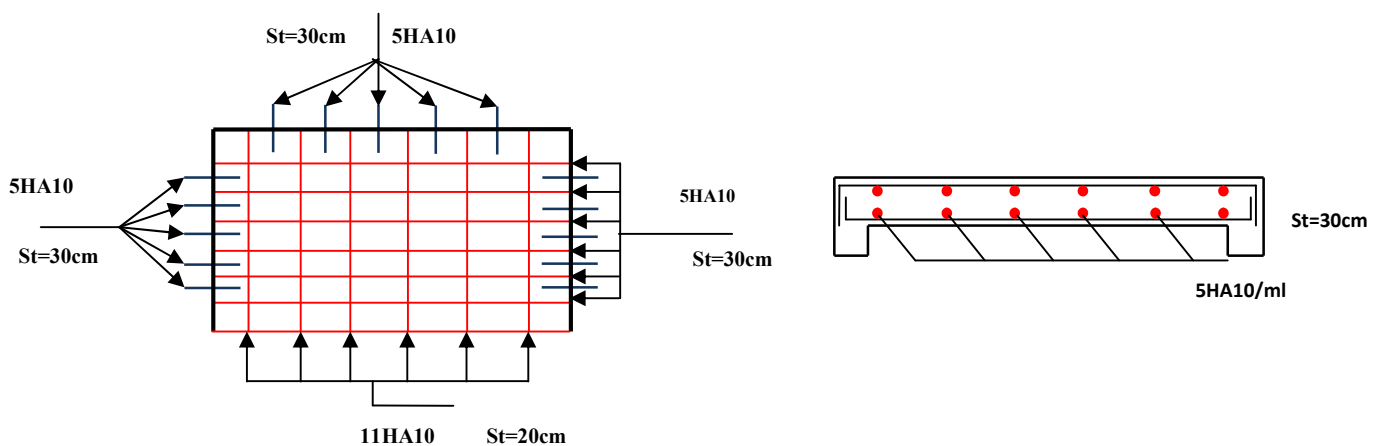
schéma de ferrailage de la dalle D2 sur trois appuis
